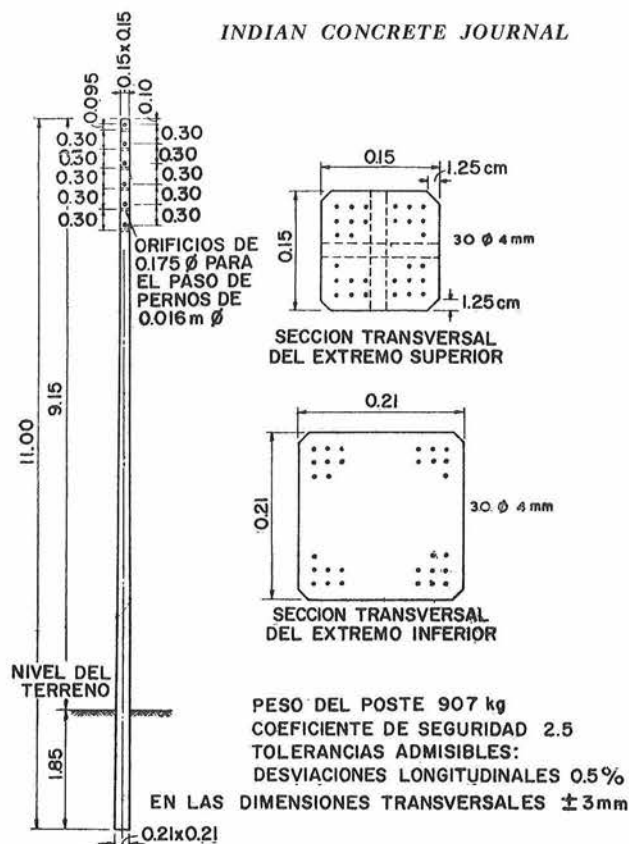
Detalle de uno de los postes de hormigón pretensado, de sección transversal cuadrada, tipo 36/400.
